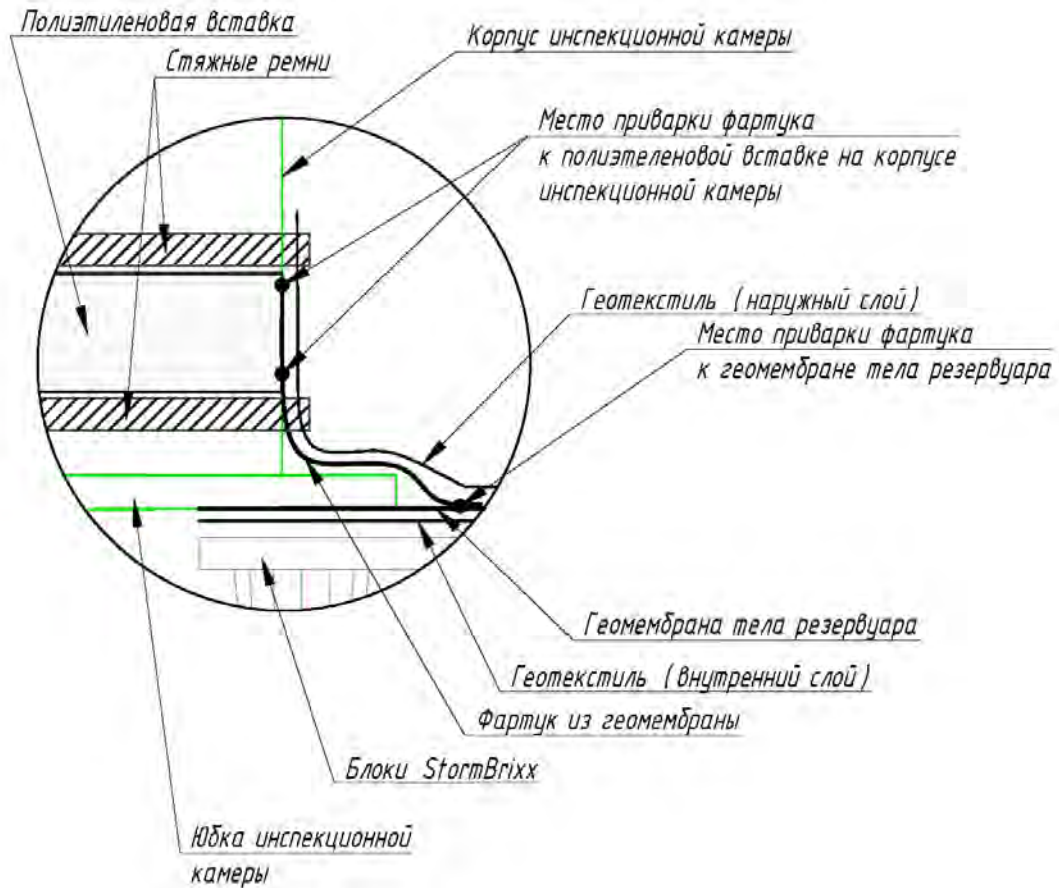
Схема крепления материалов покрытия к горловине из стеклопластика
